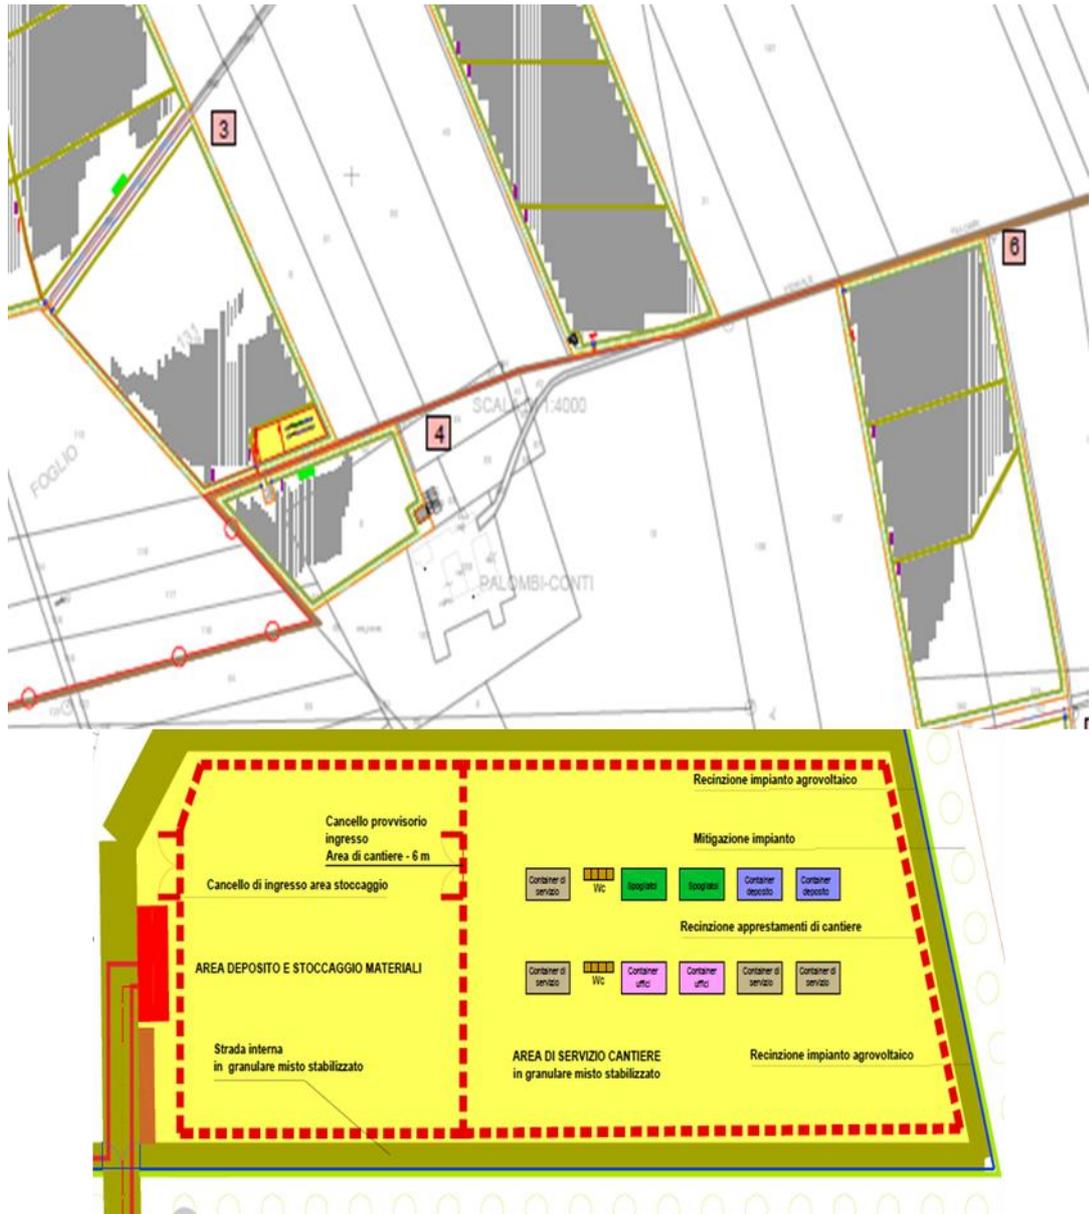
Area di cantiere interna all'area di impianto con dettaglio dell'area di deposito e baracche di cantiere
